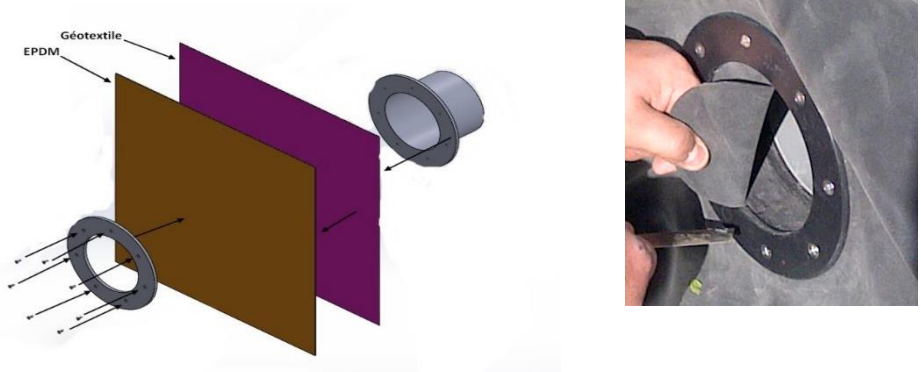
Schéma de principe et photo d'une traversée de paroi.
